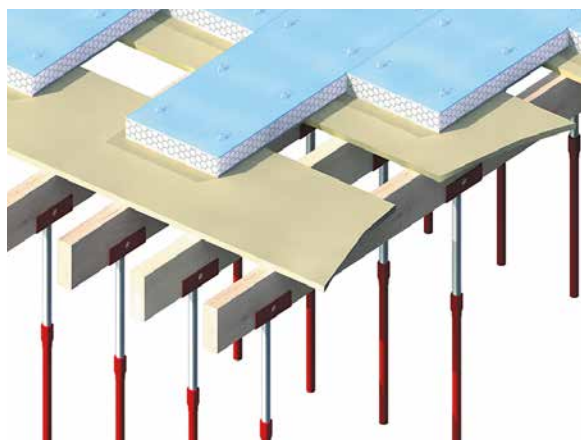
Mise en place des panneaux en coffrage isolant traditionnel
